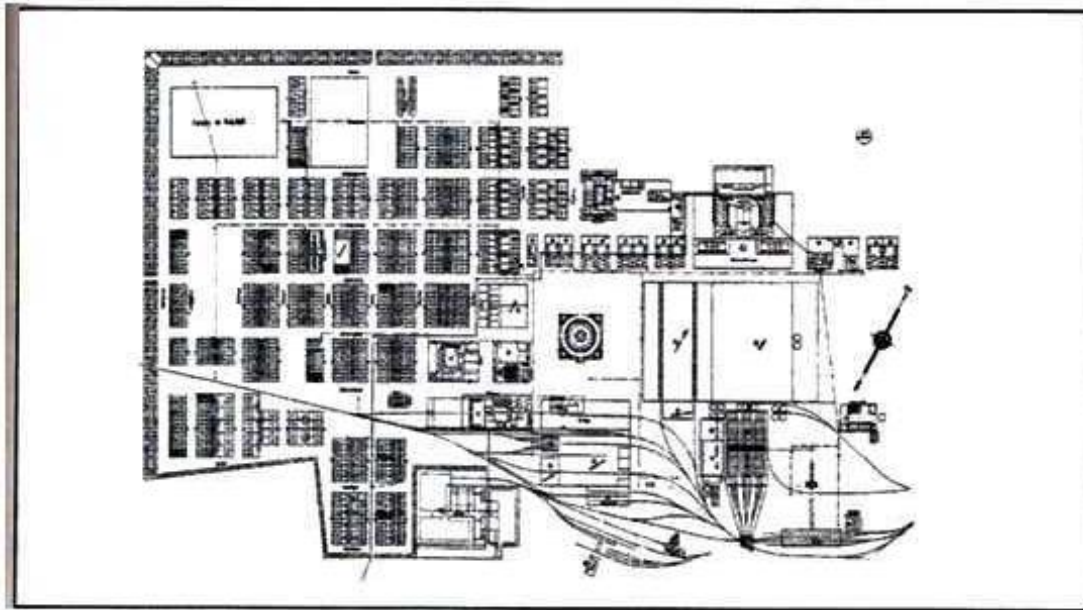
Plano del campamento minero de Chacabuco, Chile. Fuente: Garcés (1999)
